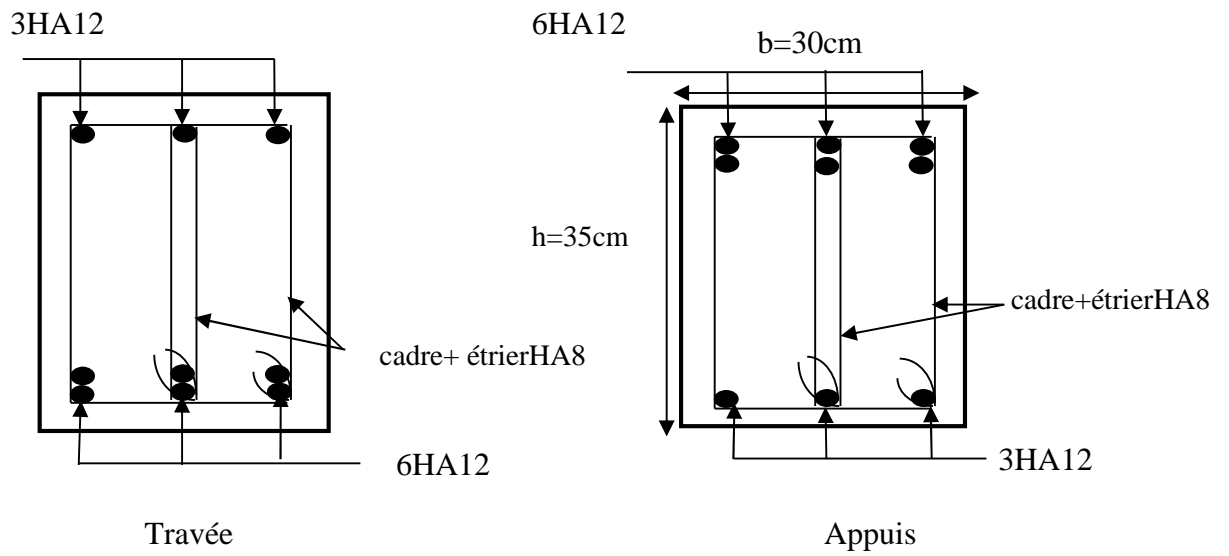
schémas de ferrailage des poutres secondaires étage (2,3,4,5)
